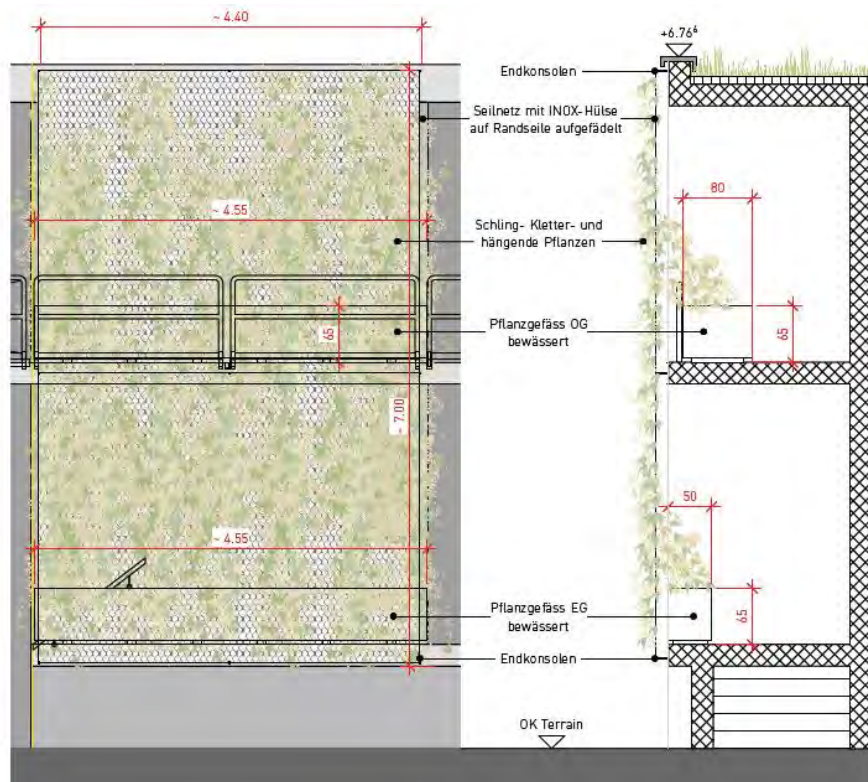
Façade rideau installée sur la façade nord-ouest du bâtiment de la pépinière de Zürich
